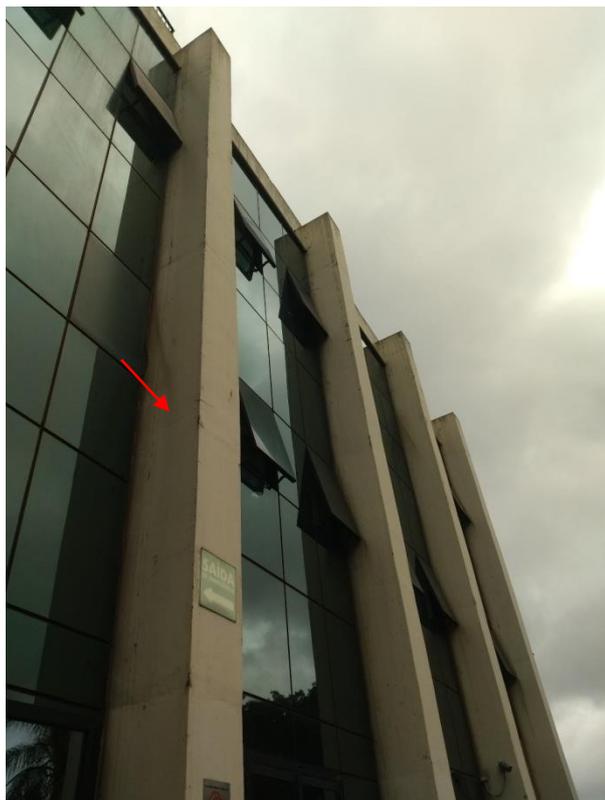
Fachada da Rua Colômbia – Notar fissuras localizadas no 4º andar e pele de vidro no entorno dos pilares
